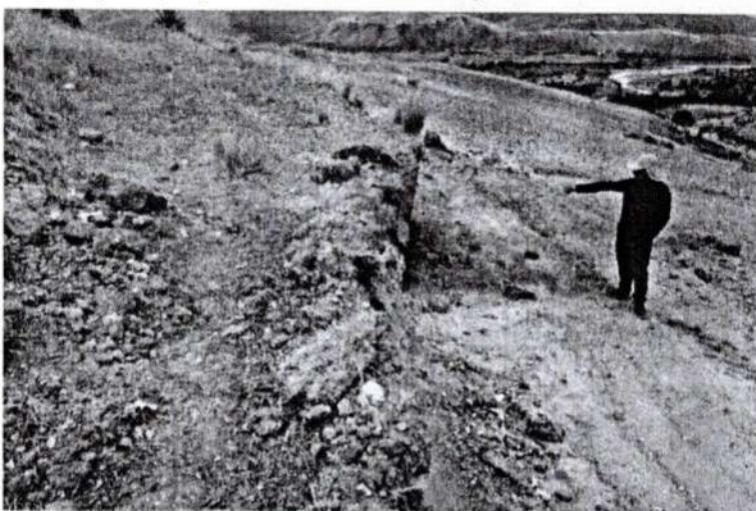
Vista del Qhapaq ñan, donde se evidencia el corte de la calzada y plataforma realizado con maquinaria pesada. (inspección técnica 13/10/2025).
